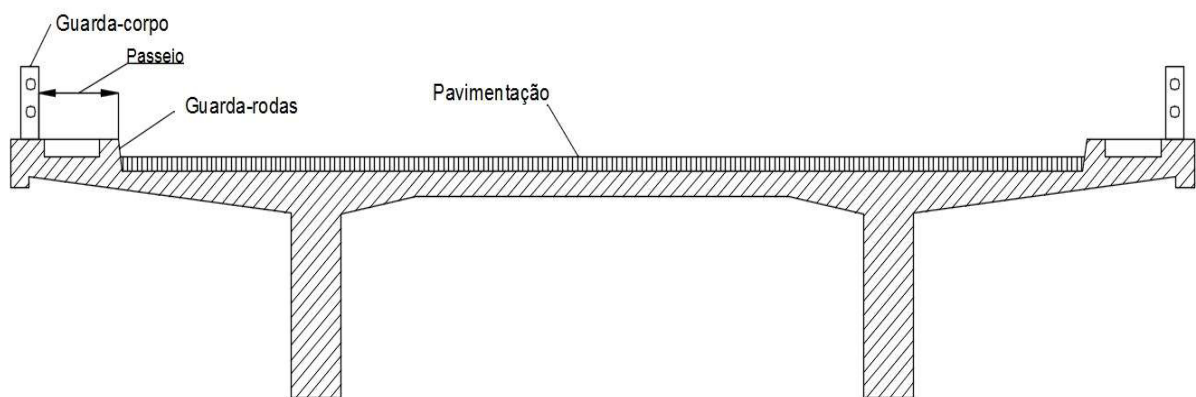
Elementos da Superestrutura. Fonte: Próprio Autor
